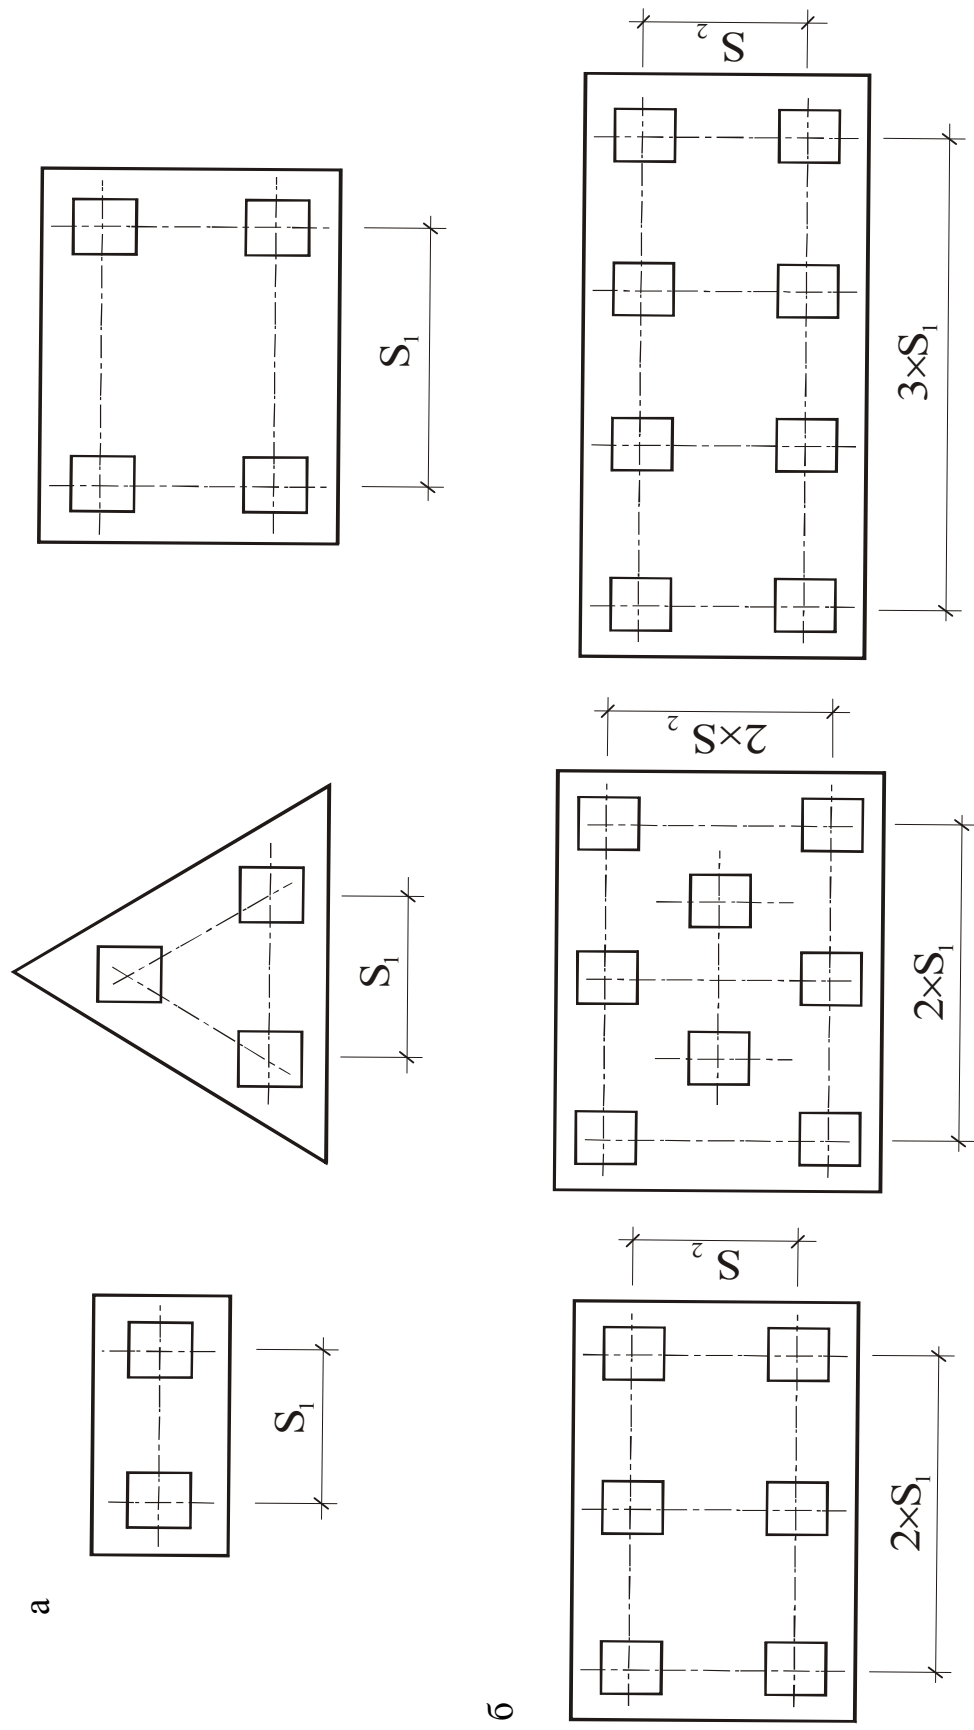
Примеры расположения свай в свайных фундаментах под колонну:
